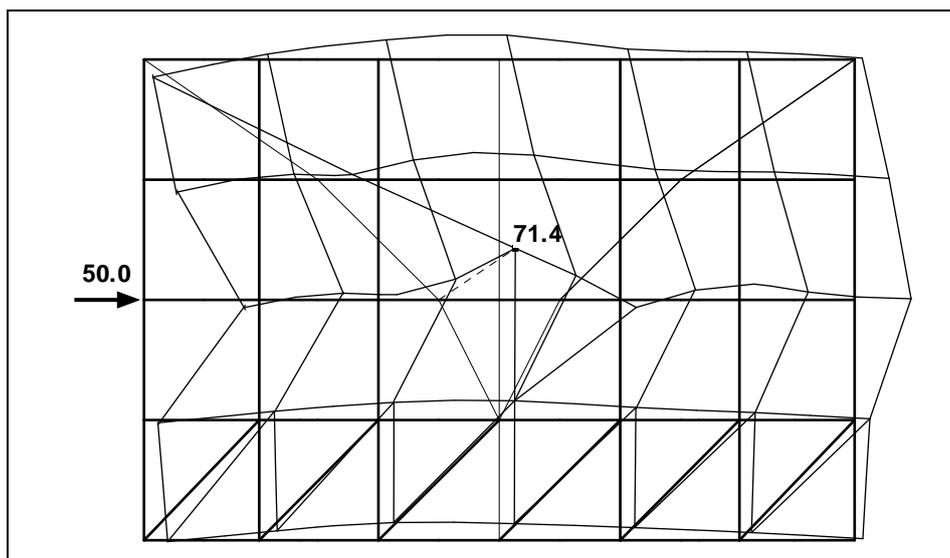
Teilansicht (Grundriss) des Systems mit den Verformungen unter einer Einzellast
